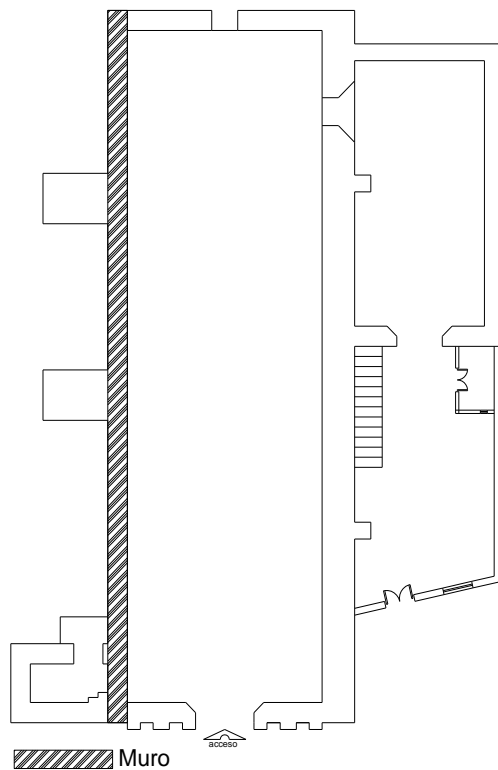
Muros de mampostería, y diversos tipos de piedras que se encuentran en la Capilla de San Nicolás Tolentino. Autor JOBG, Año. 2017
